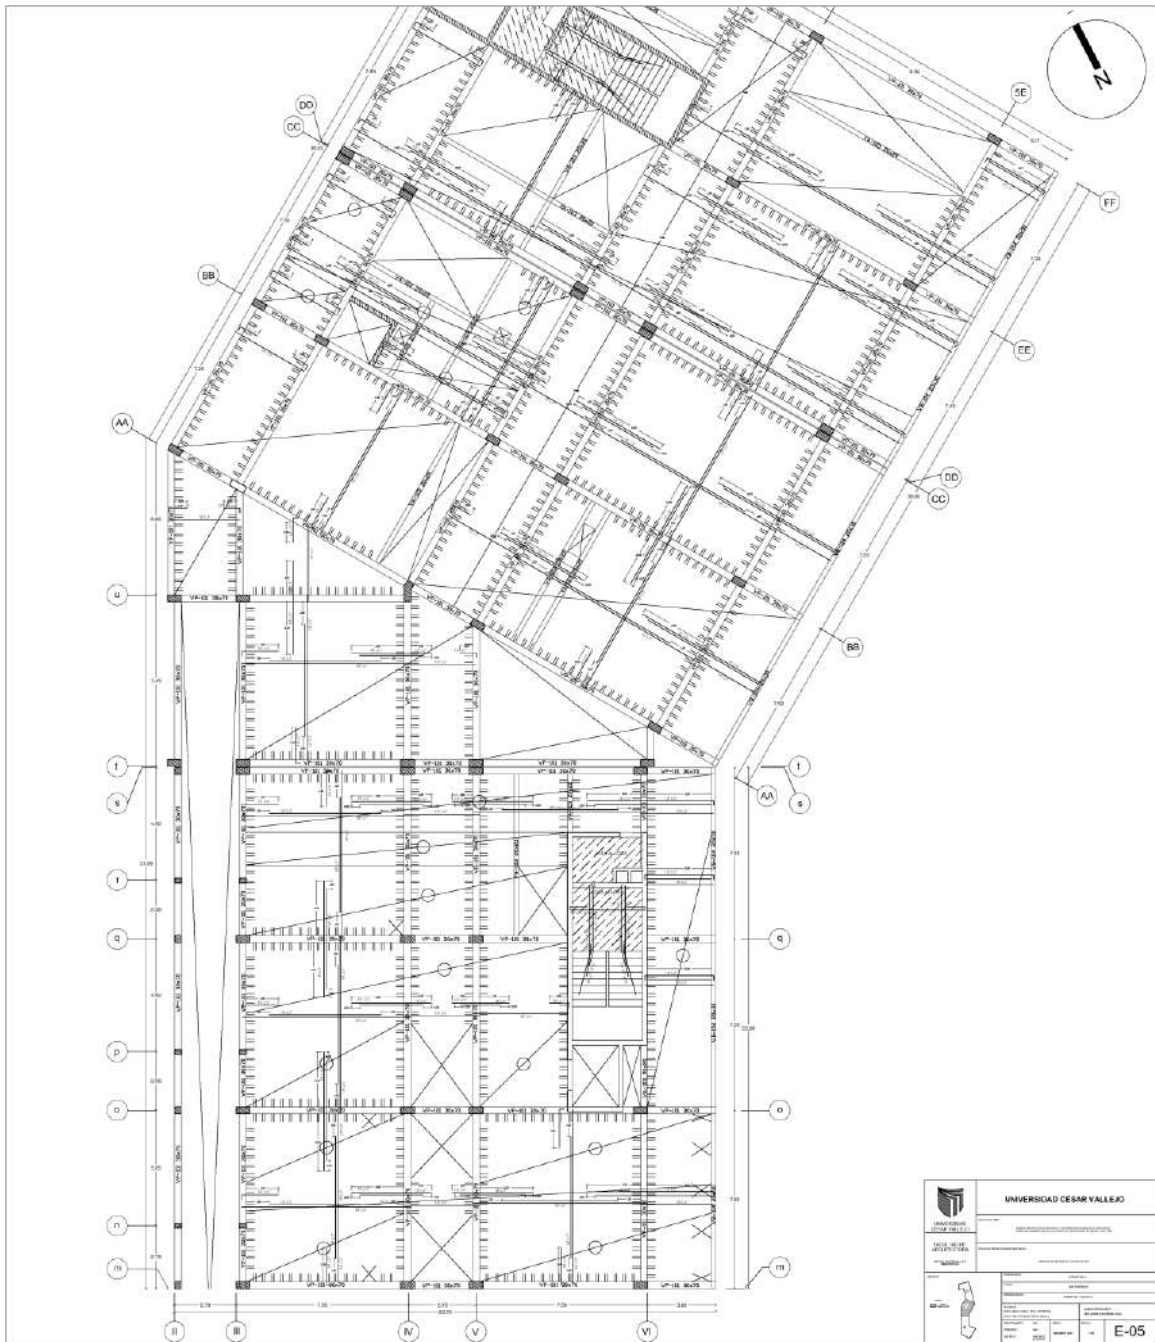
Aligerado - Primer piso sector C - ESTRUCTURAS
